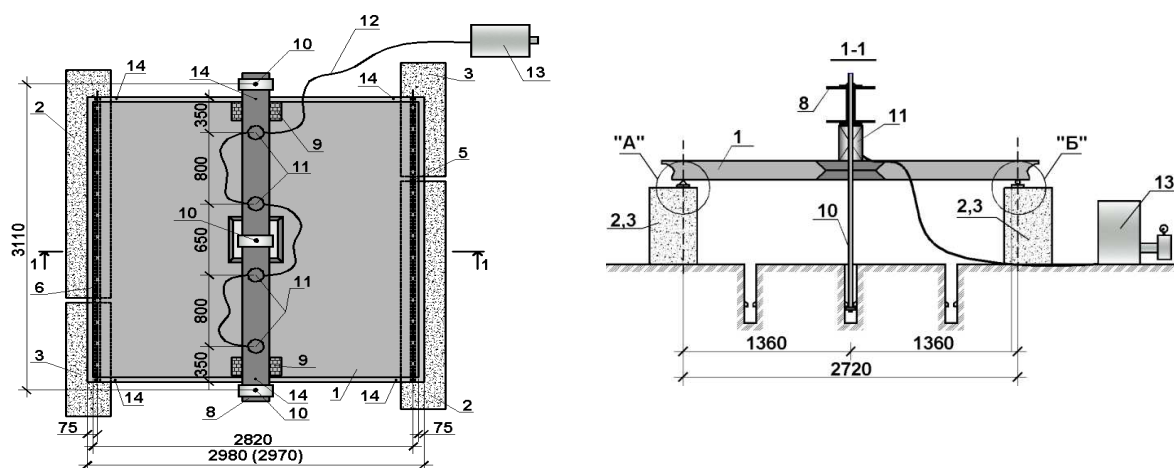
Стенд для випробування надколонної плити: 1 – плита ПН 30.30.1,6–2–1; 2 – блок ФС; 3 – блок ФС; 5 – рухома опора; 6 – нерухома опора (L50x5;100x8); 8 – траверса із швелерів №30; 9 – тимчасові опори; 10 – тяжі з арматури; 11 – гідравлічні домкрати; 12 – напірні трубопроводи; 13 – насосна станція; 14 – індикатори
